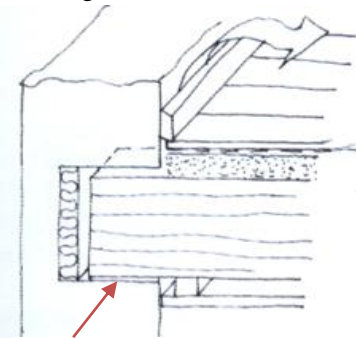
Ligação entre madeira e alvenaria com lâmina de material impermeável na zona de apoio.
